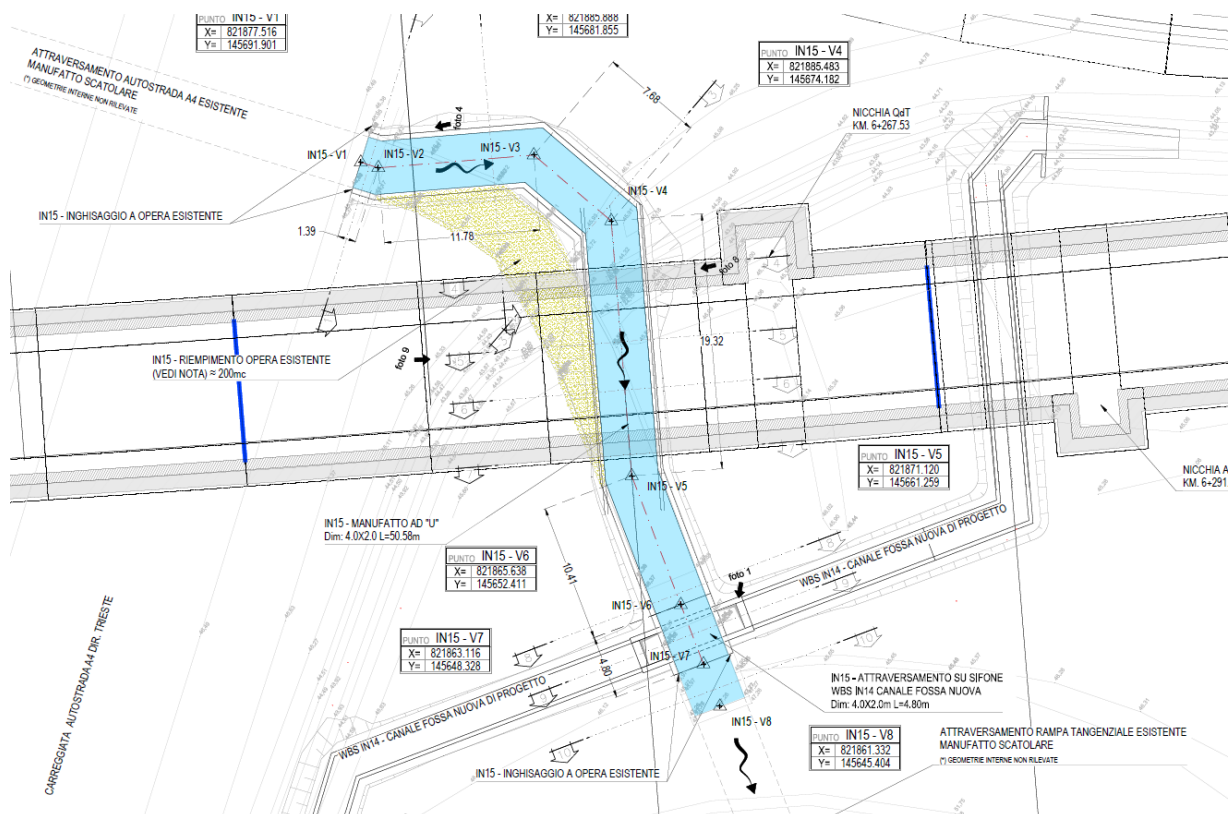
Planimetria di inquadramento delle opere in progetto – IN15
